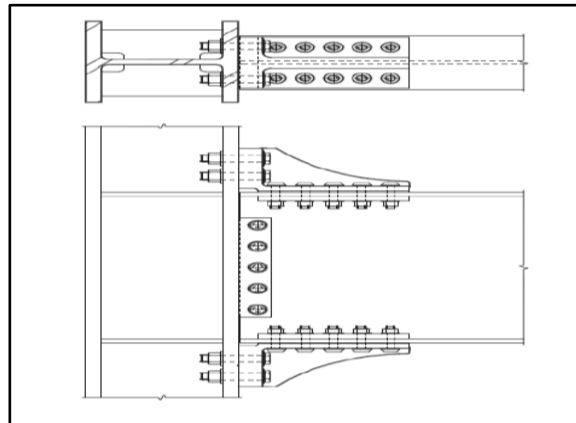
Modelo de conexión de soporte atornillado KAISER (KBB). AISC358 (2016)
